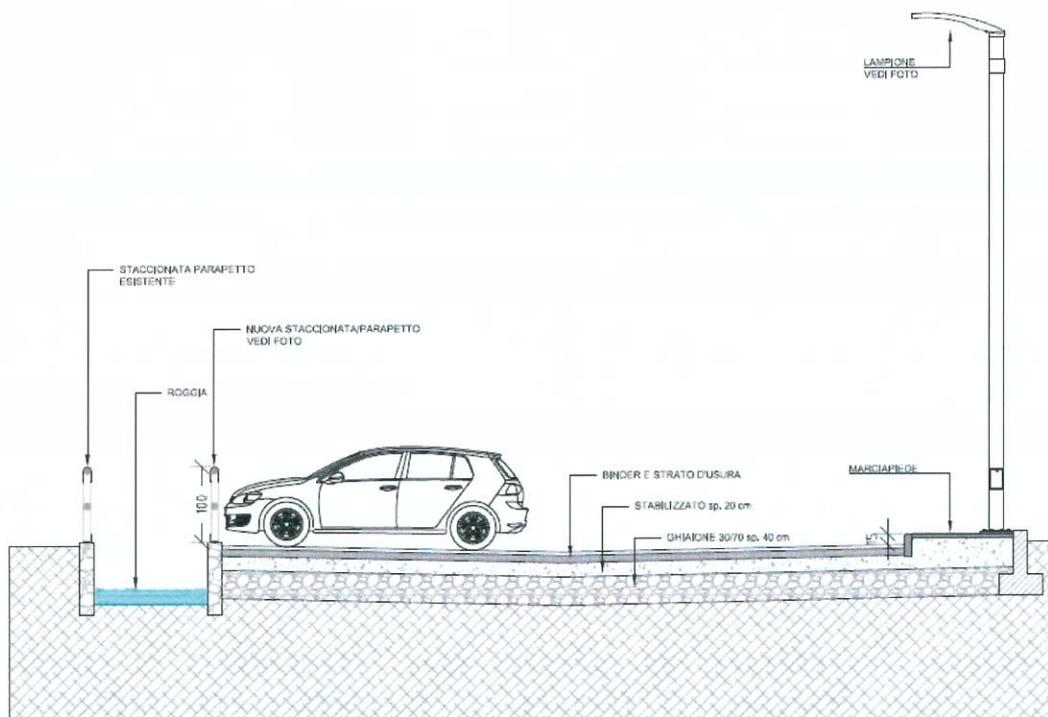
Estratto "Sezione A-A di progetto" scala a vista.
